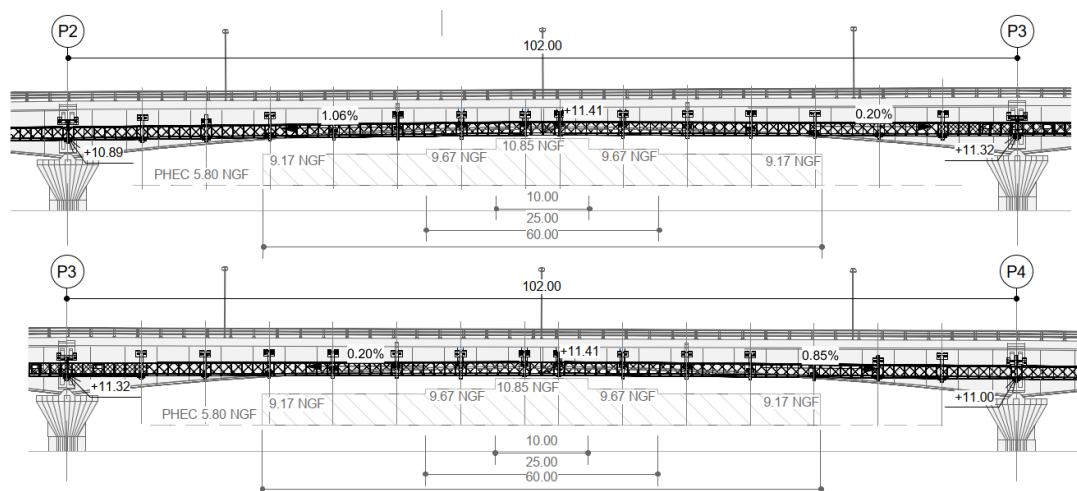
Extrait cahier de plan - Repérage des passes navigables
